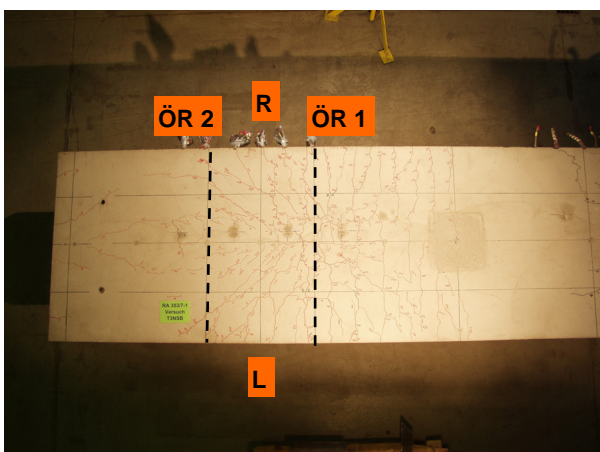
Rissbild auf der Betongurtoberseite
